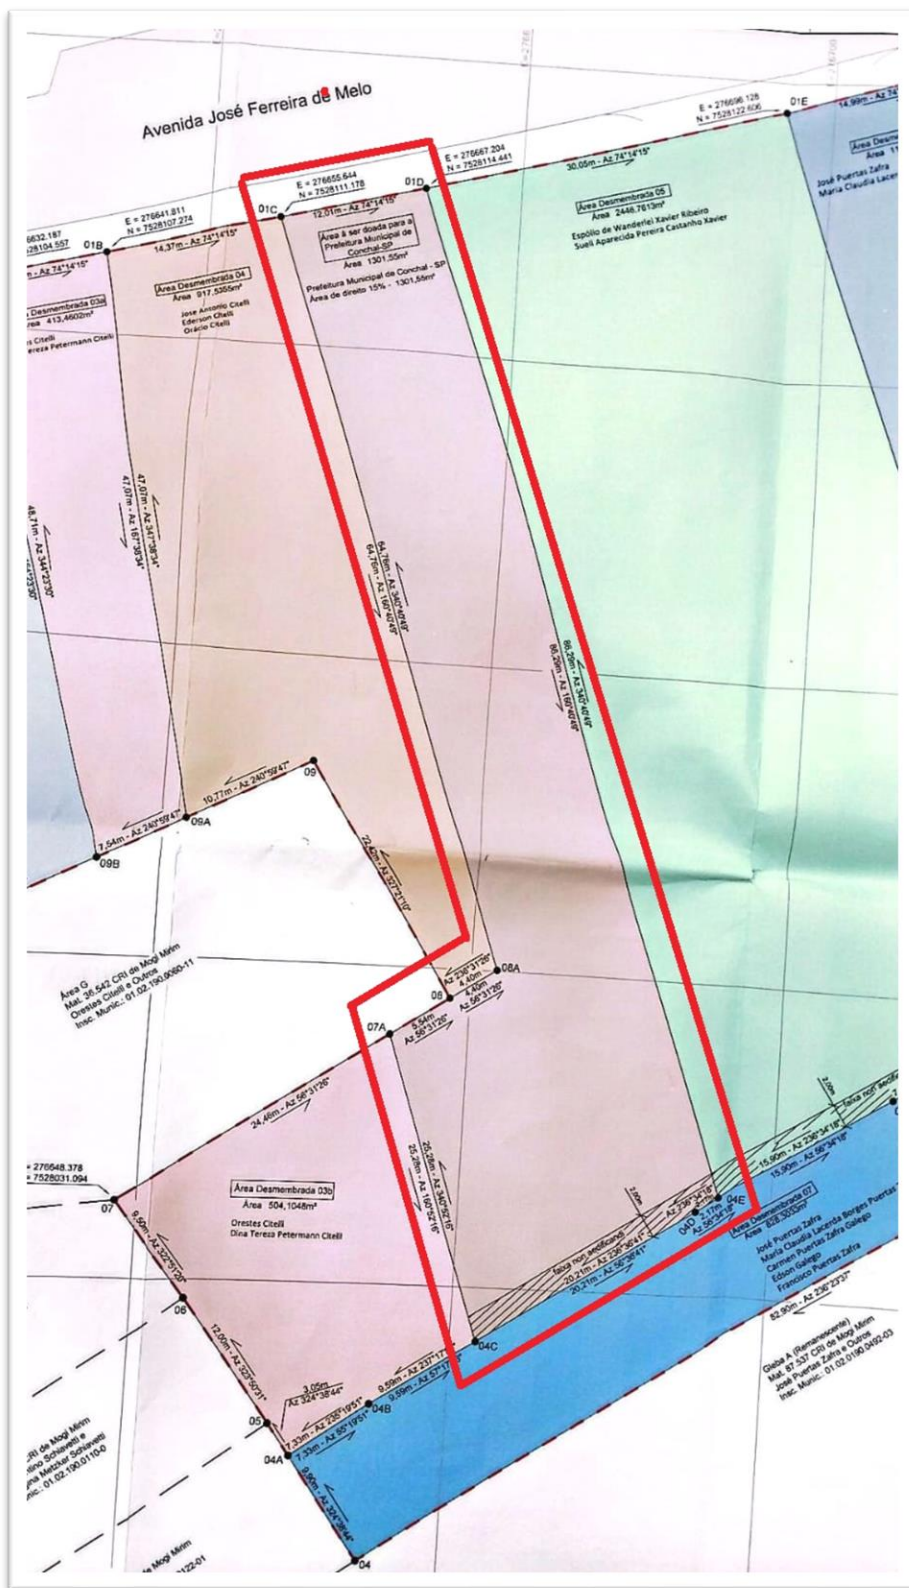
Área Doada, terreno desmembrado da Área B, com área total de 1.301,55 m²
